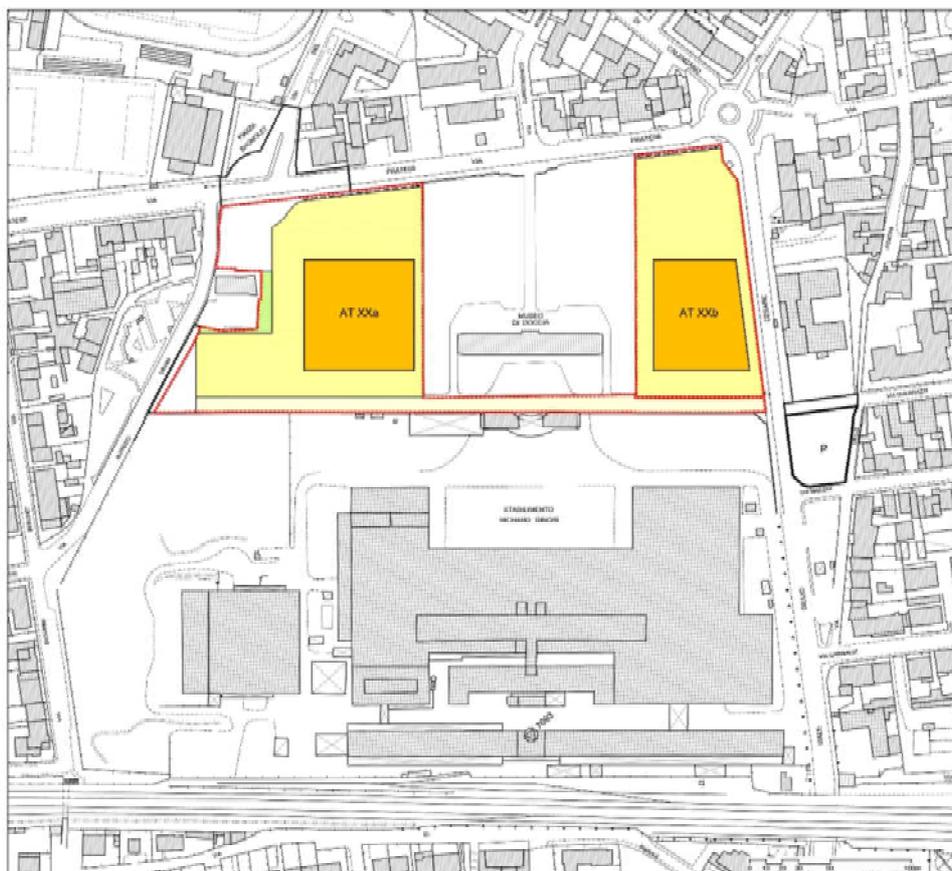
Planimetria generale con indicazione delle aree soggette a trasformazione e la loro destinazione
